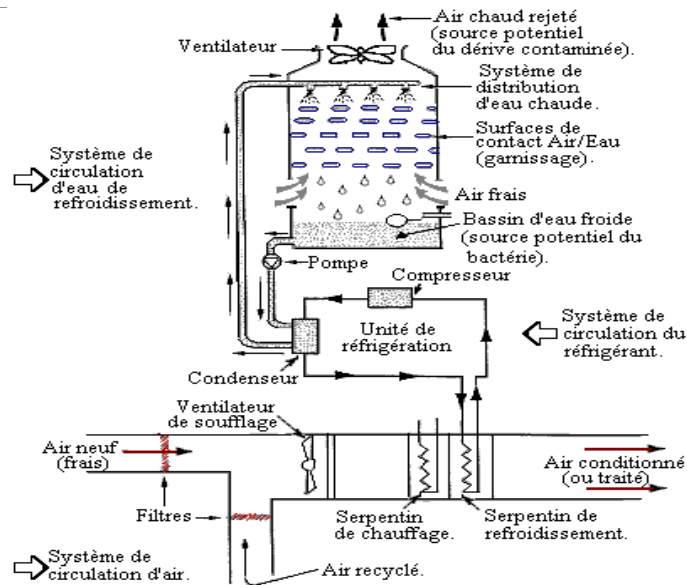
schéma d'une installation de conditionnement d'air.
